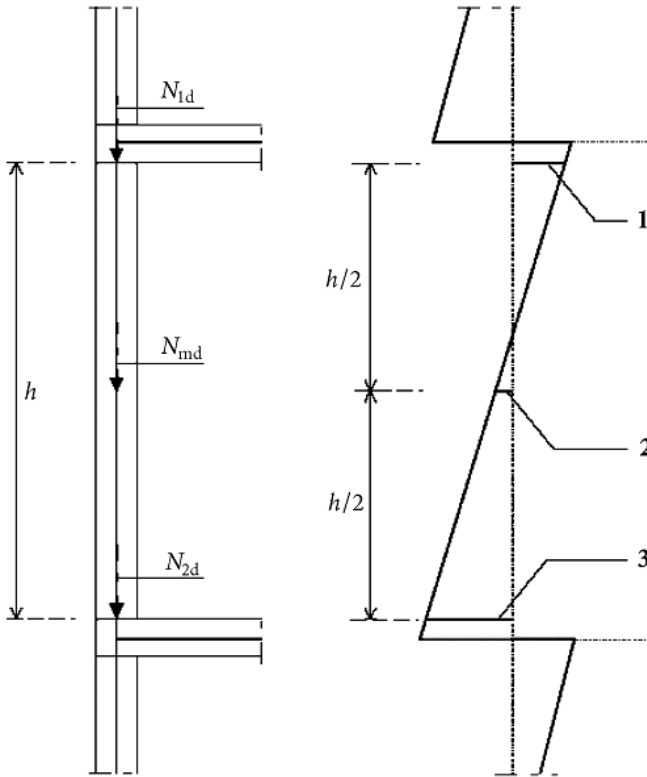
Моменти внаслідок ексцентриситету: 1 –  $M_{1d}$  на нижній стороні перекриття; 2 –  $M_{md}$  на середині висоти стіни; 3 –  $M_{2d}$  – зверху перекриття
